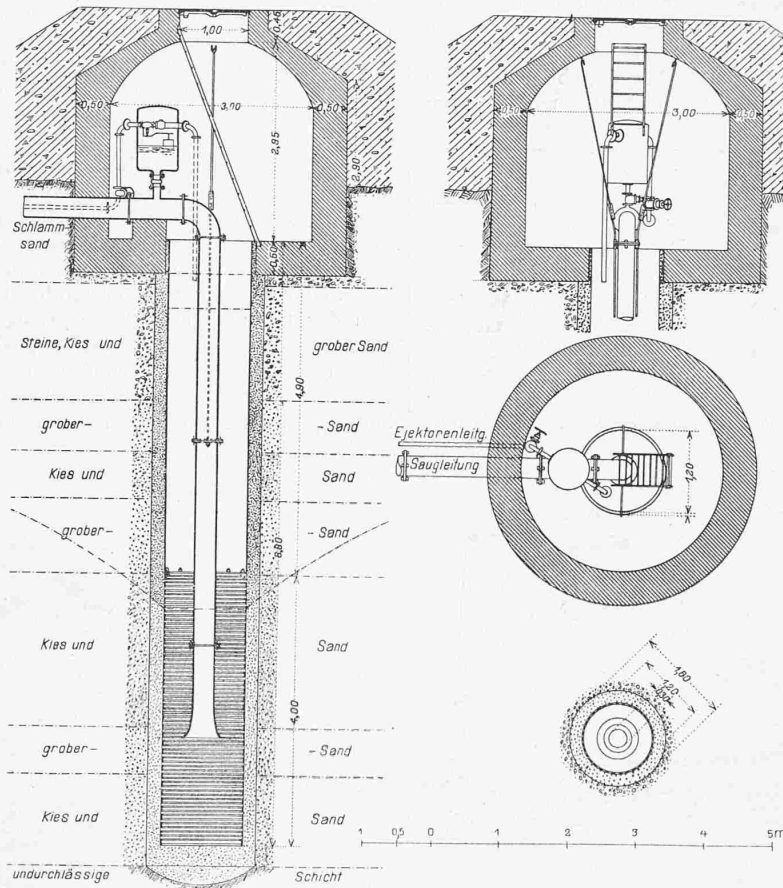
Brunnenkonstruktion. — Vertikal- und Horizontalschnitte. — Masstab 1 : 100.
